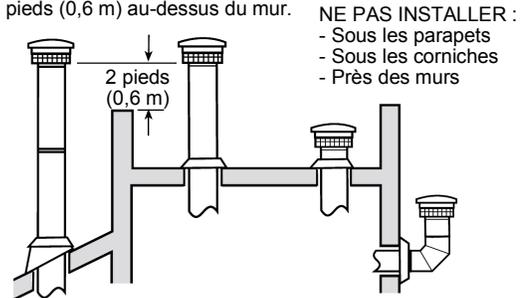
Hauteur exigée de la terminaison d'évacuation.
